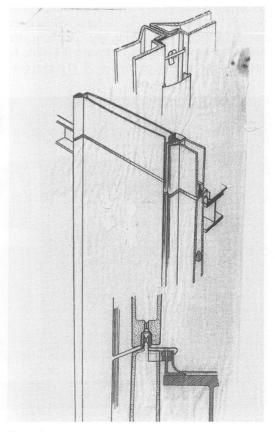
Detalle de la junta para La Casa del Pueblo (Sulze 2000)
